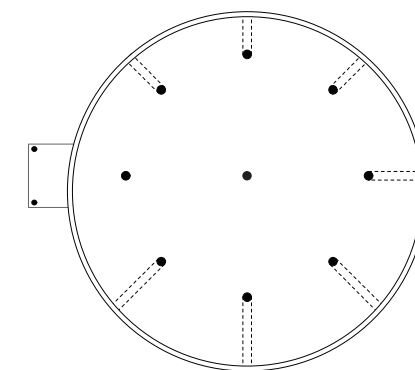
Planta de Vivienda Cónica (elaborado por el autor).
